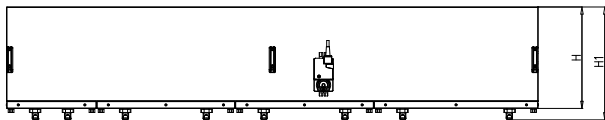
компактная установка EVO-T+ 8000 (вид снизу для подвесной версии / вид сверху для лежащей версии).
